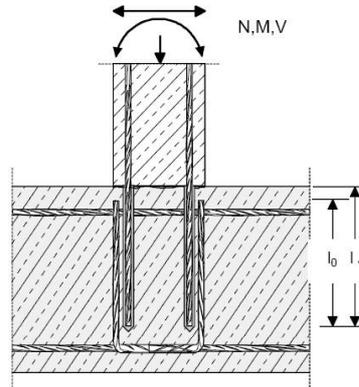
giunzione per sovrapposizione di pilastri sollecitati a flessione o muri a fondazioni.
